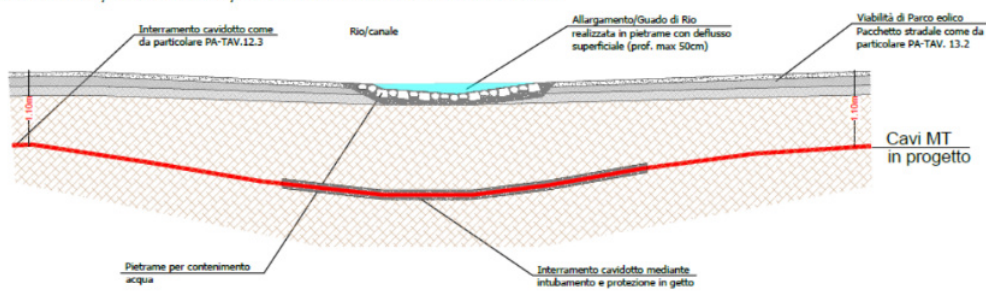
sezione tipo attraversamento rio con tecnica T.O.C.
